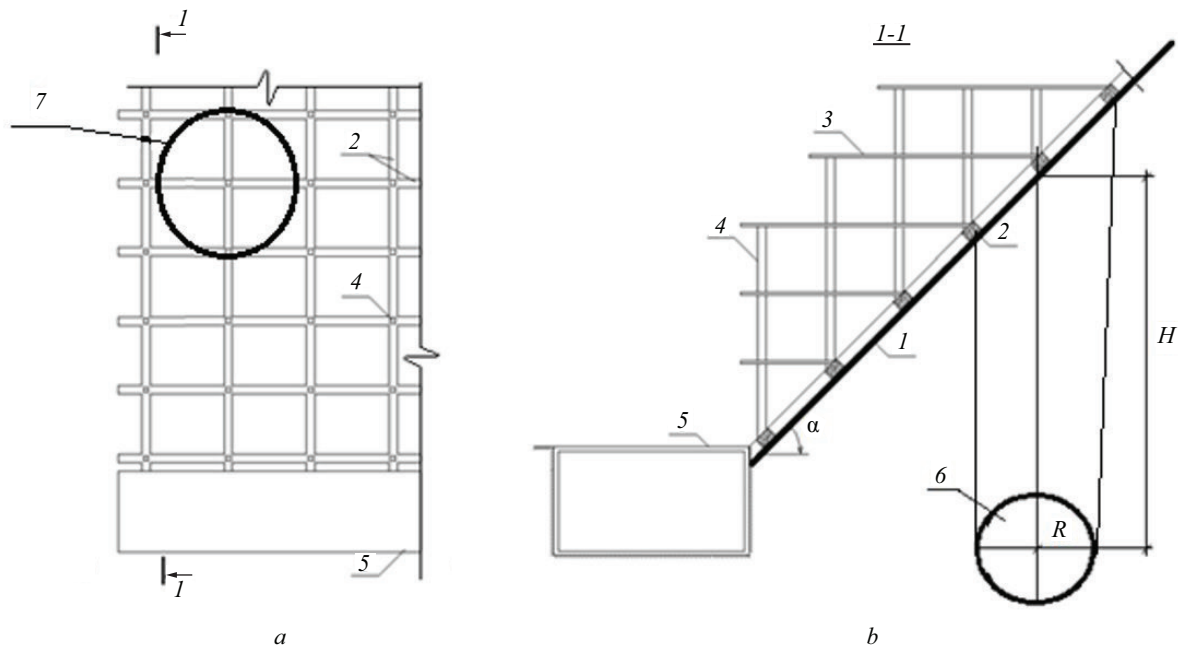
Схема здания на склоне: 1 — продольные балки фундаментной решетки; 2 — поперечные балки фундаментной решетки; 3 — диски перекрытий; 4 — вертикальные несущие элементы (колонны); 5 — удерживающая заглубленная конструкция; 6 — карстовая воронка; 7 — проекция карстовой воронки на плоскость склона
